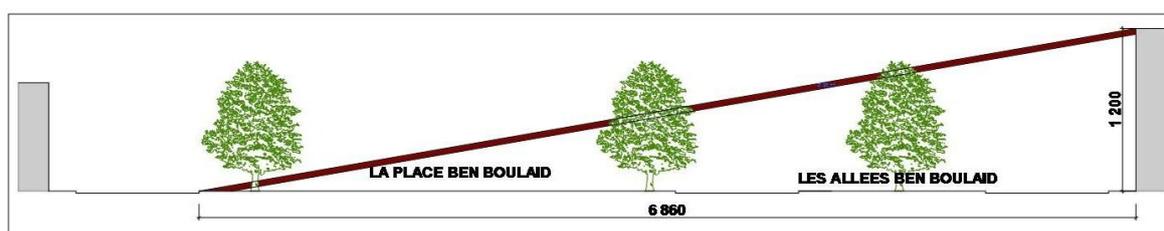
Rapport entre la largeur de la place et la hauteur des constructions, côté des allées Ben Boulaid, place Ben Boulaid. Source : Auteur.
